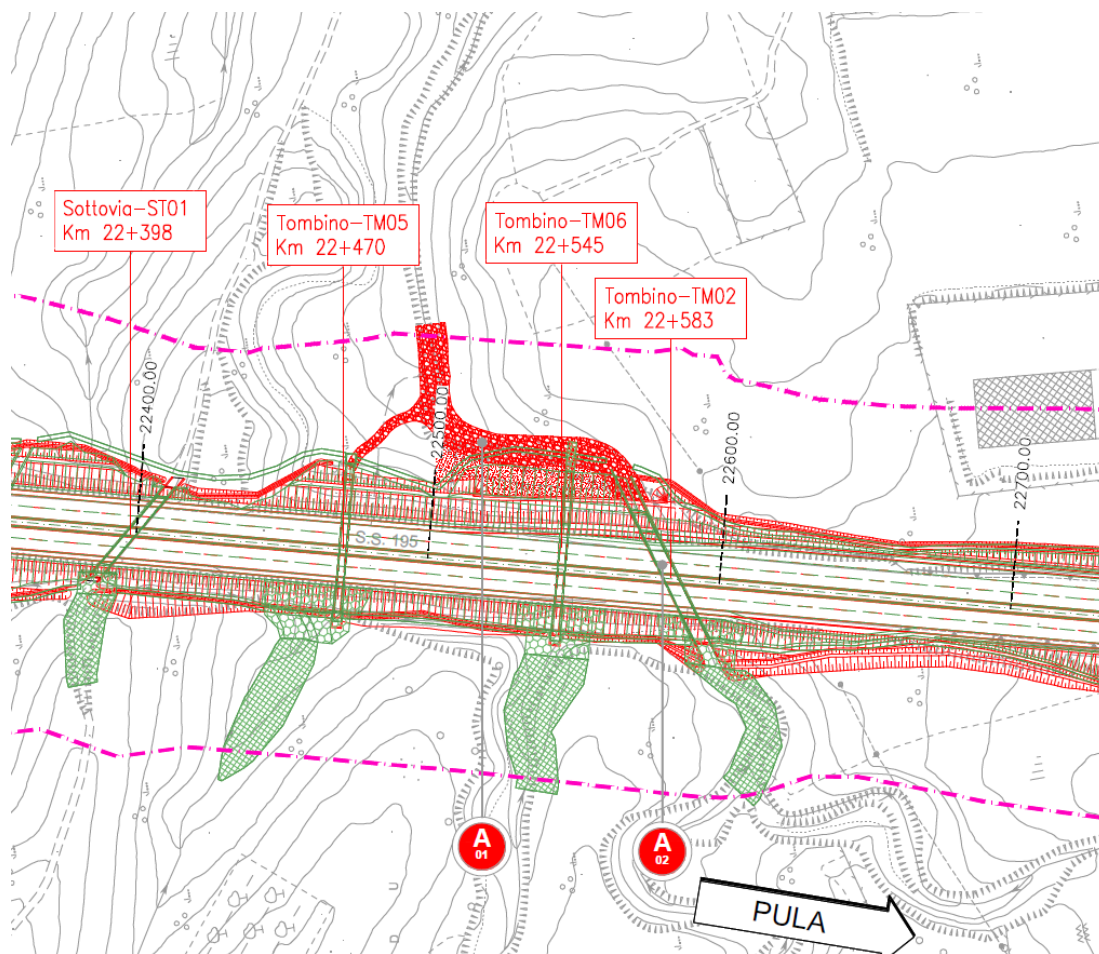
Stralcio sovrapposizione planimetrica sistemazione tombino km 22+540
